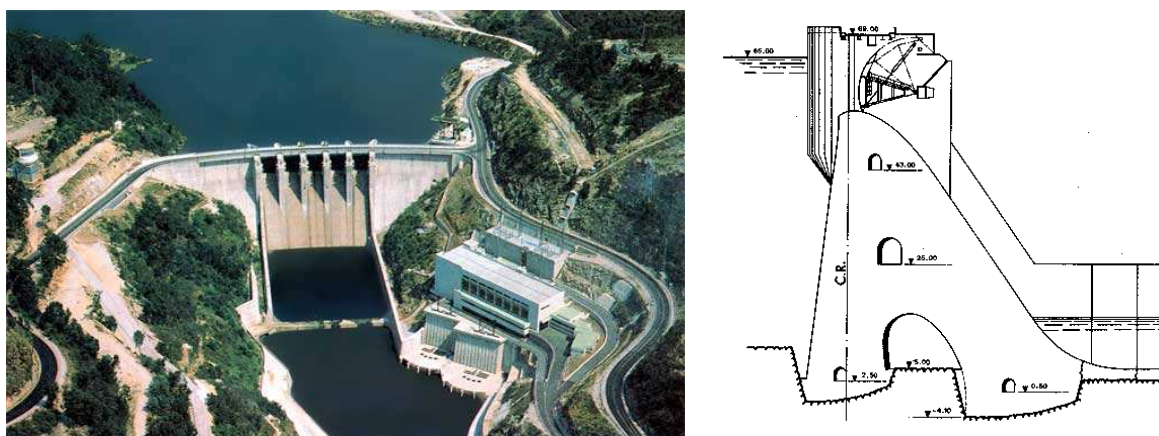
Barragem do Torrão. Vista aérea de jusante e perfil transversal (fonte: www.cnpqb.inag.pt)
